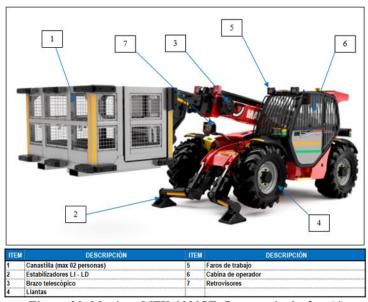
Manitou MTX-1030ST- Partes principales. (4)
